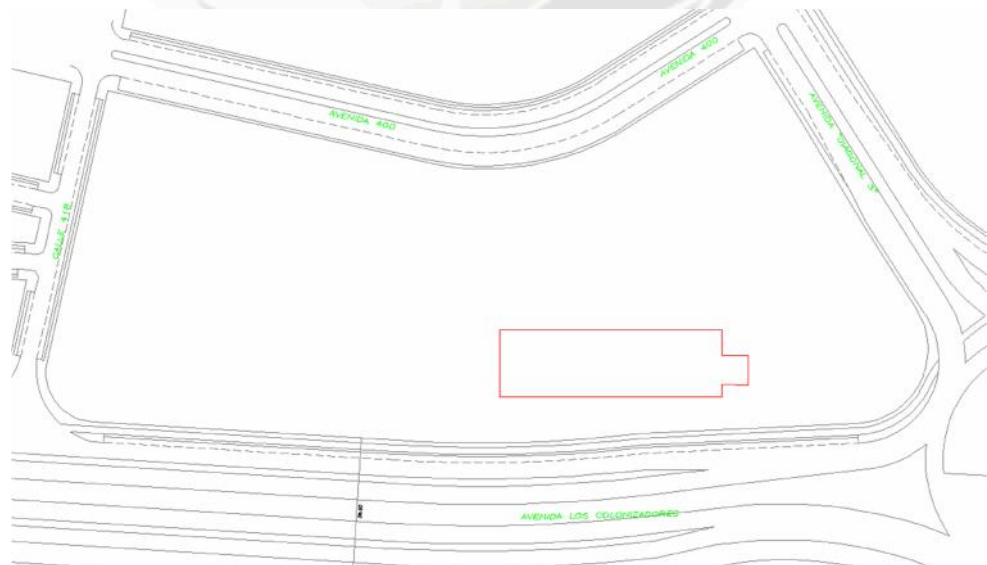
Vista ubicando edificio del nuevo terminal en el terreno.
